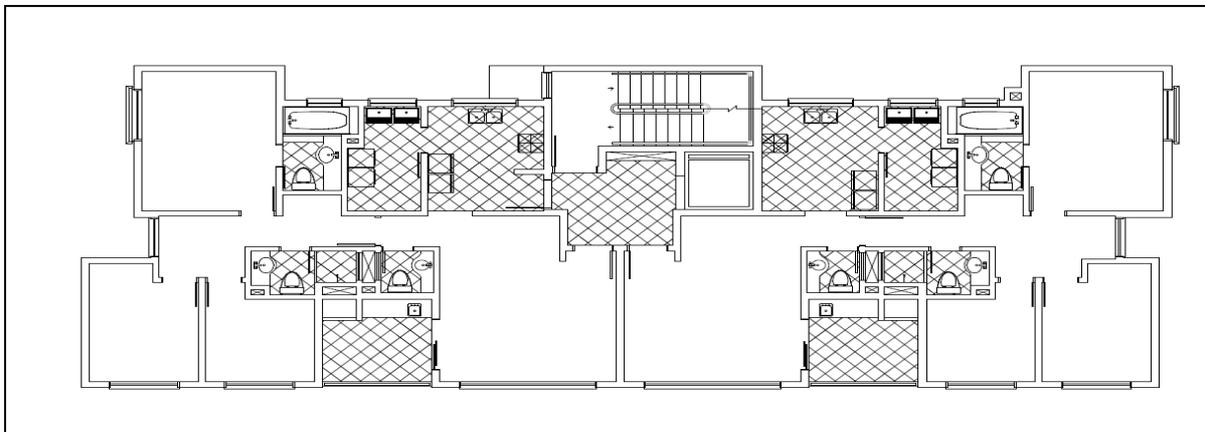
Planta Baixa do Pavimento Tipo.
